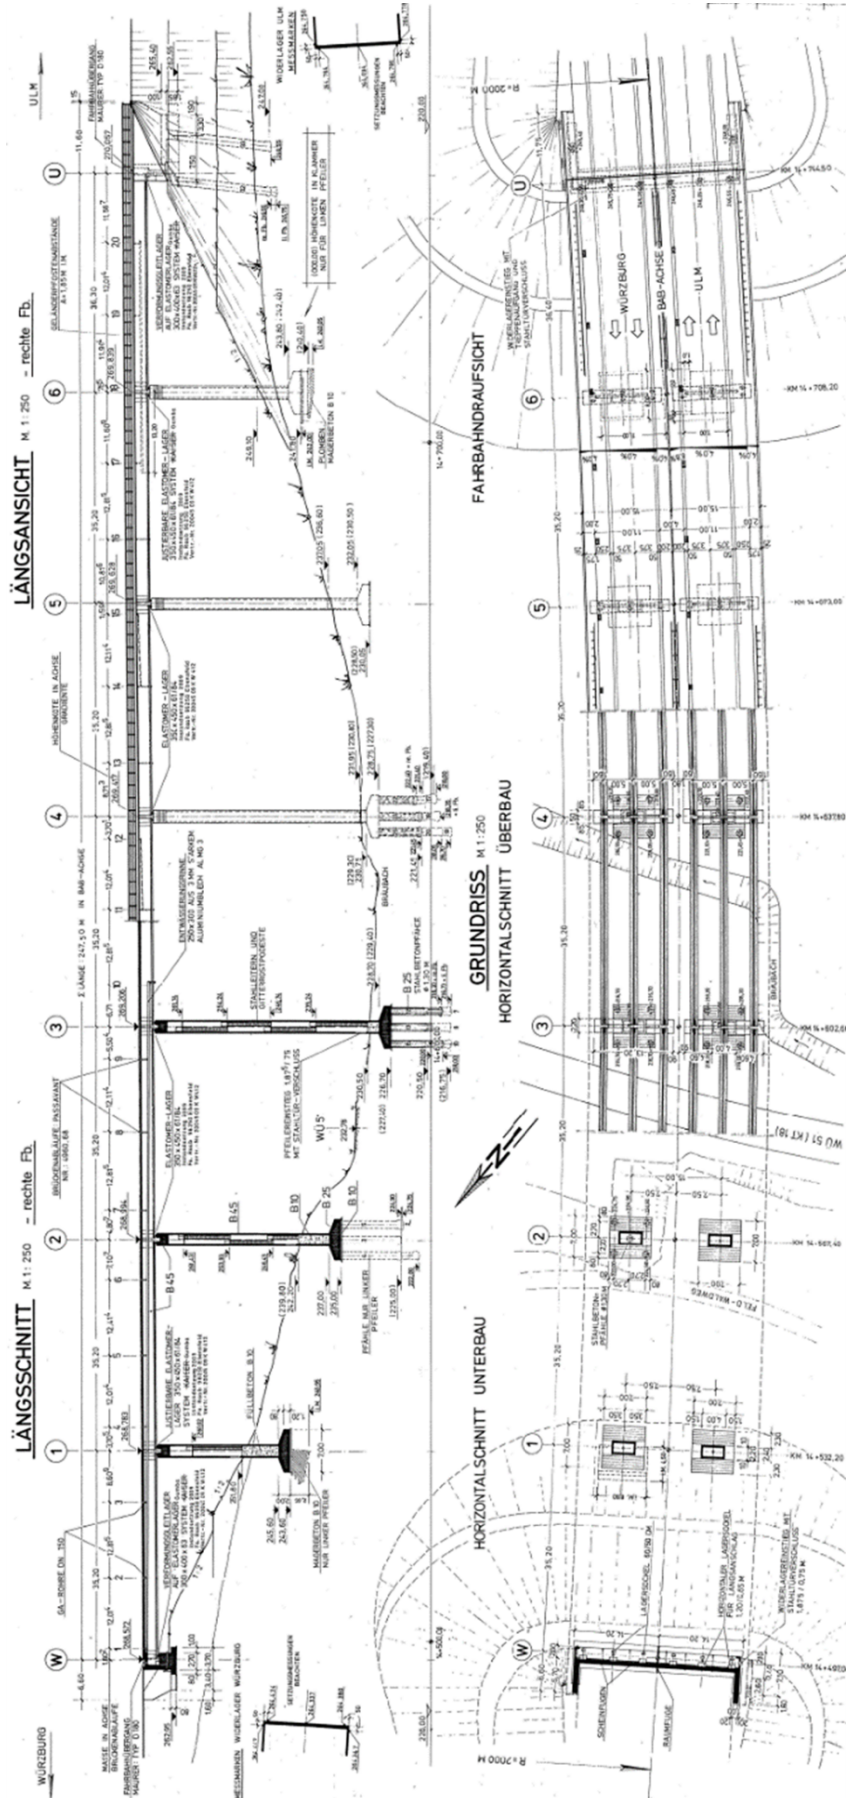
Längsansicht/-schnitt und Draufsicht der Bräubachtalbrücke (Quelle: ABDNB)
